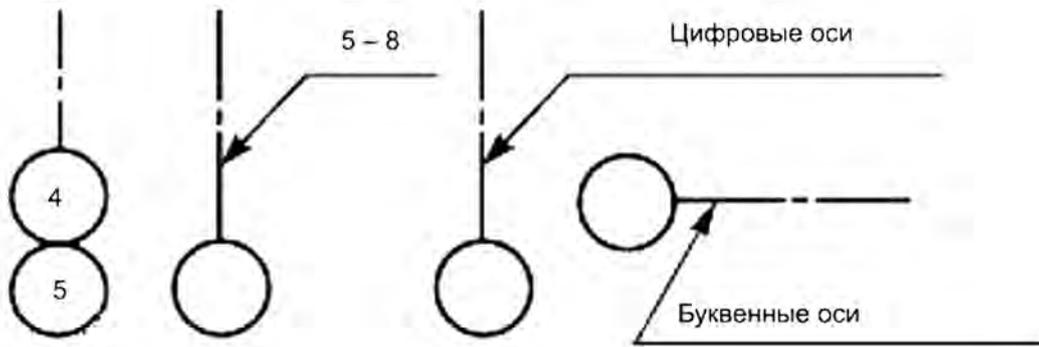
б. Вид координатных осей на чертеже узлов железобетонных конструкций
